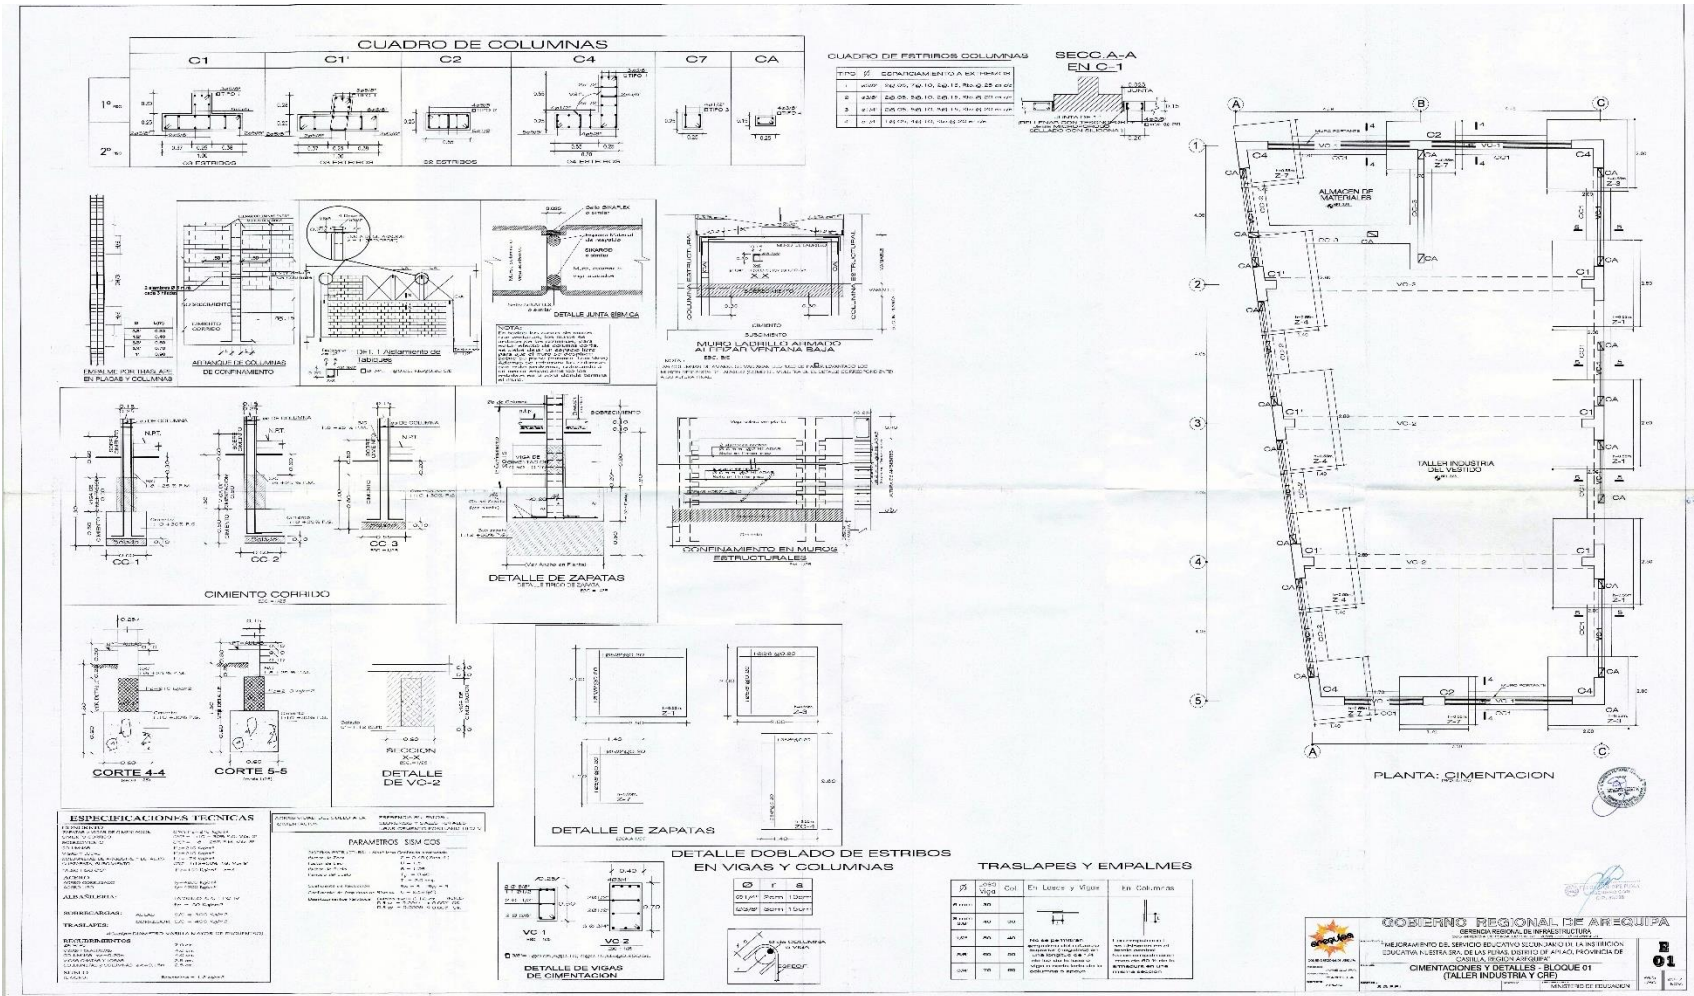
Plano de estructura – Planta del bloque 01 Taller de industria del vestido.
